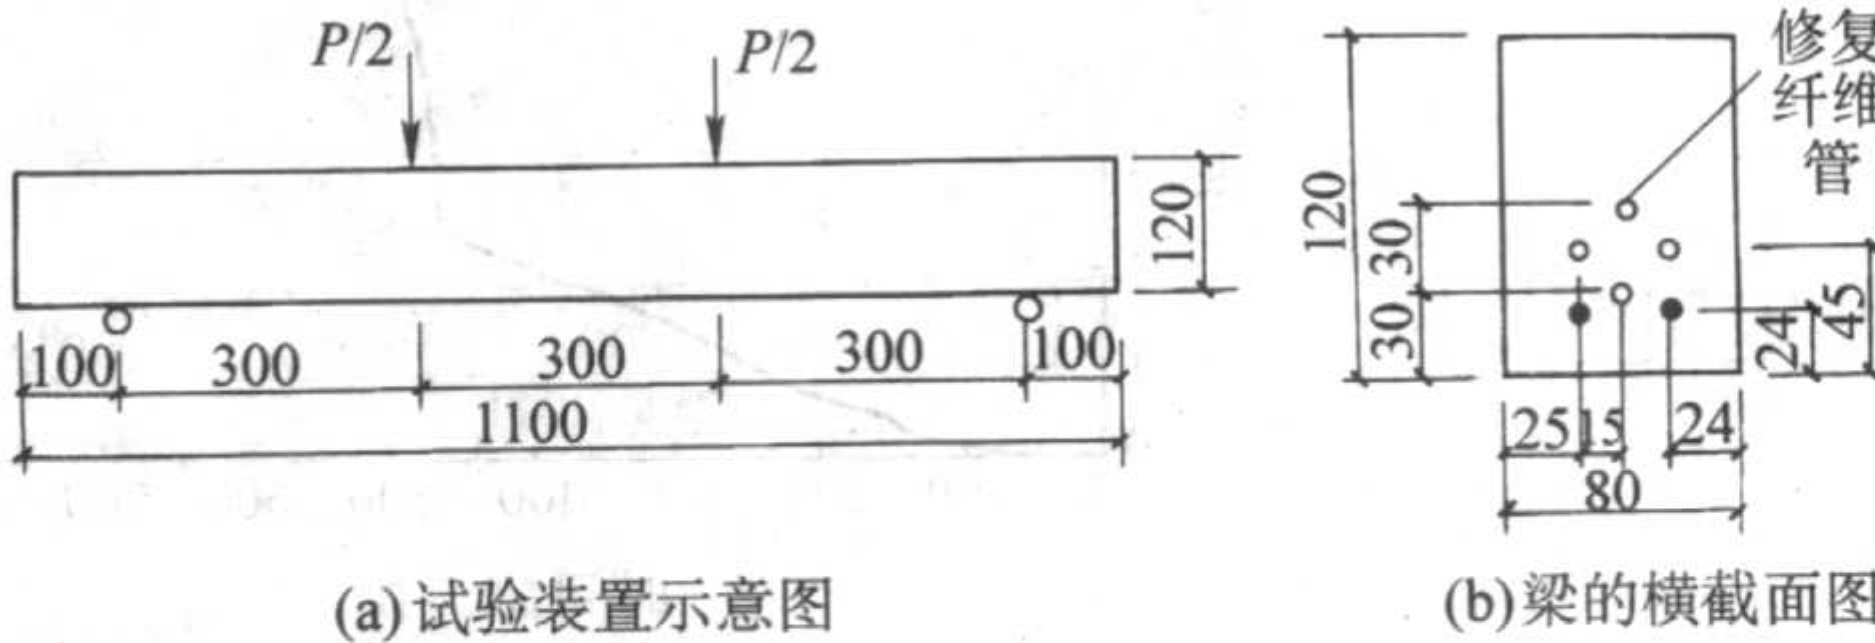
内置纤维胶液管钢筋混凝土裂缝自修复试验
